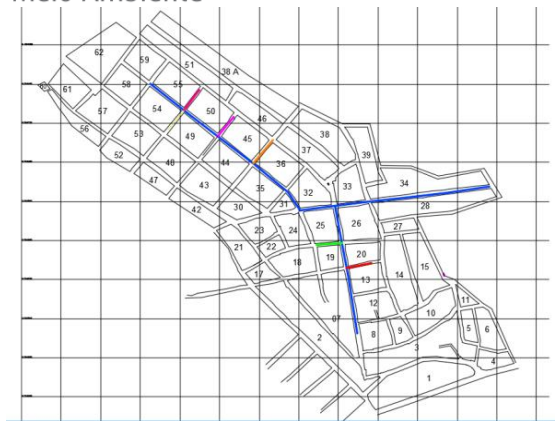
Planta do loteamento, redimensionado. Fonte: Autoral
